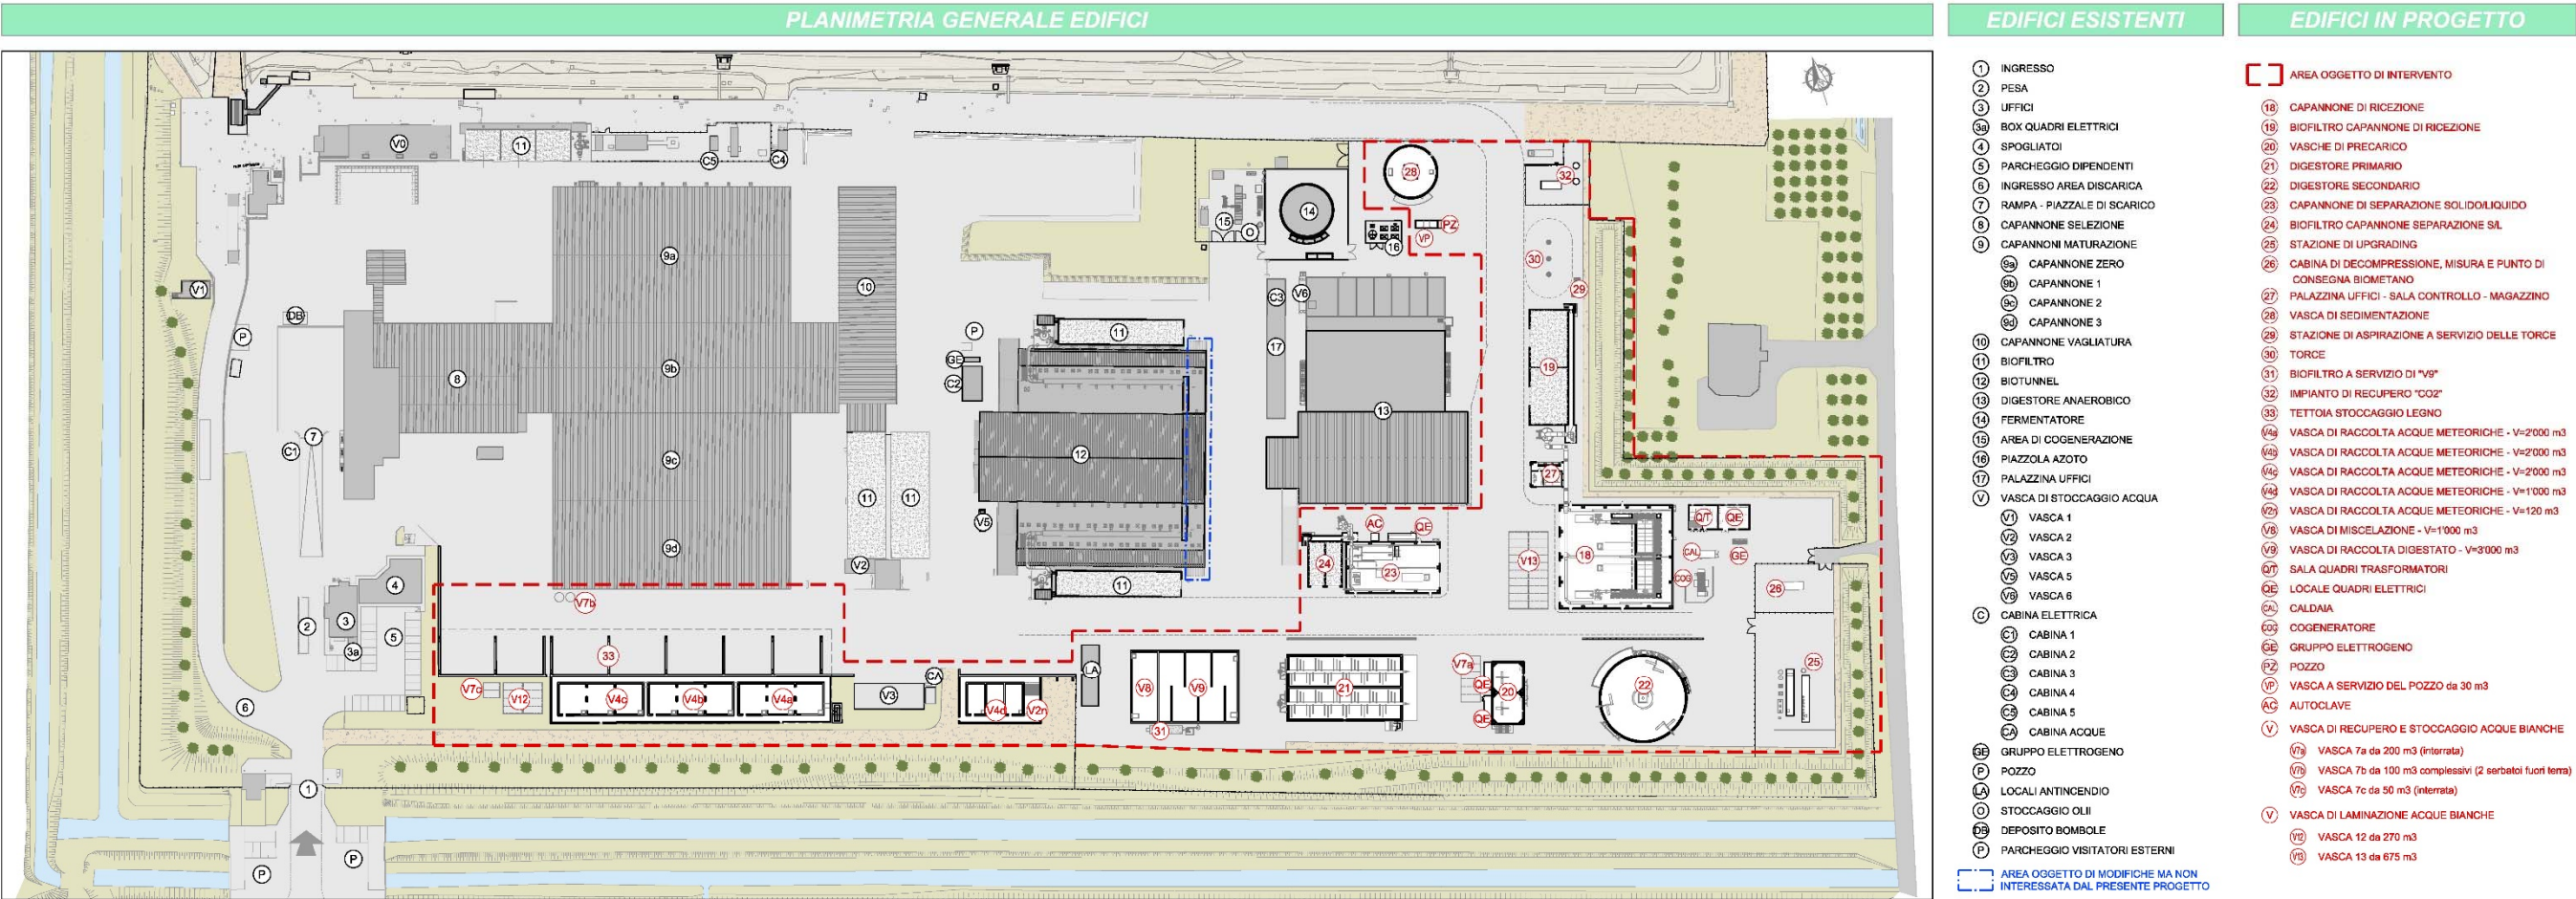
Planimetria dello stato di progetto con indicazione dell'area di intervento e dei nuovi fabbricati
